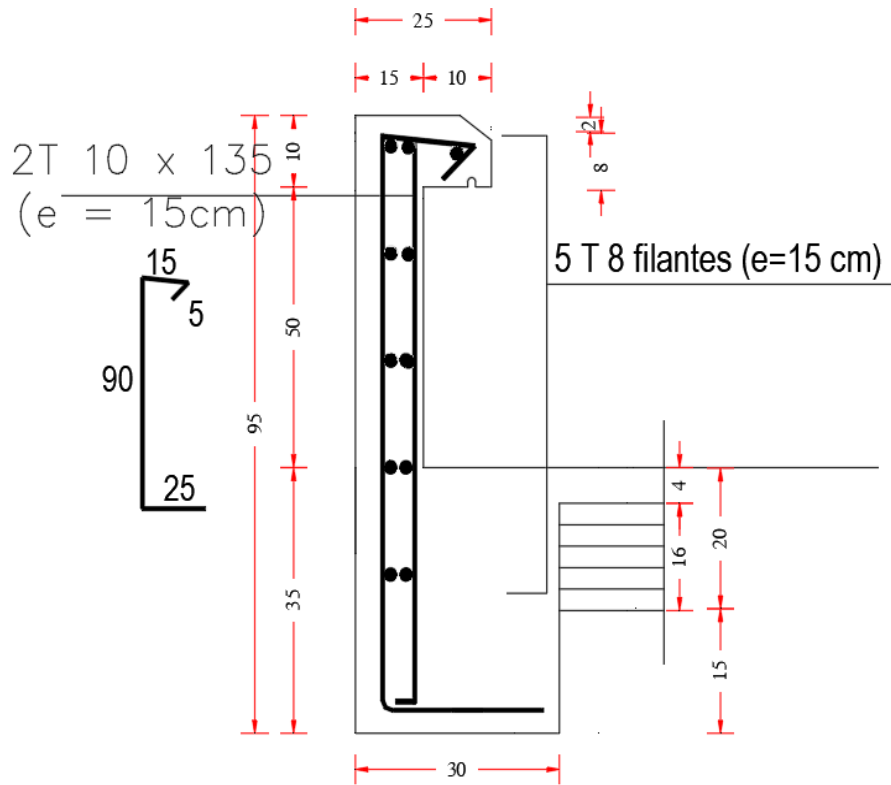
Schéma de ferrailage de l'acrotère.
